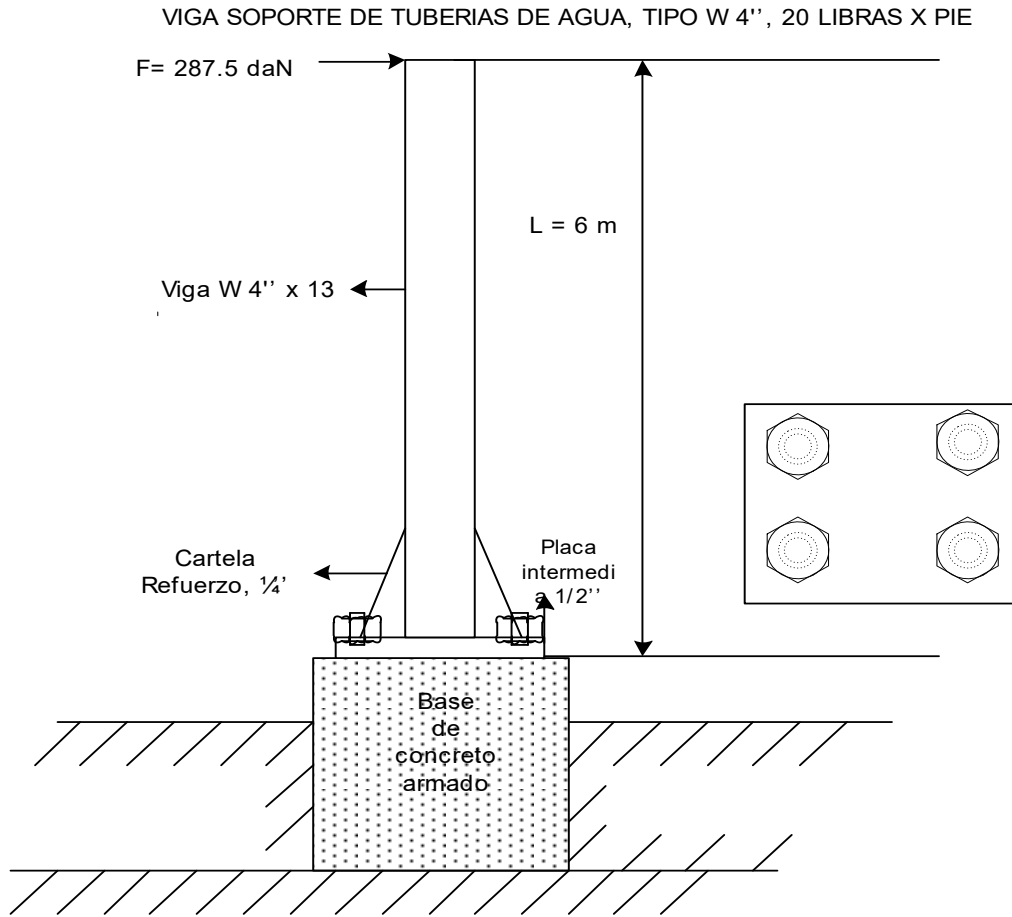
esquema para cálculo de cimentación de soportes para tubos. Elaboración propia
